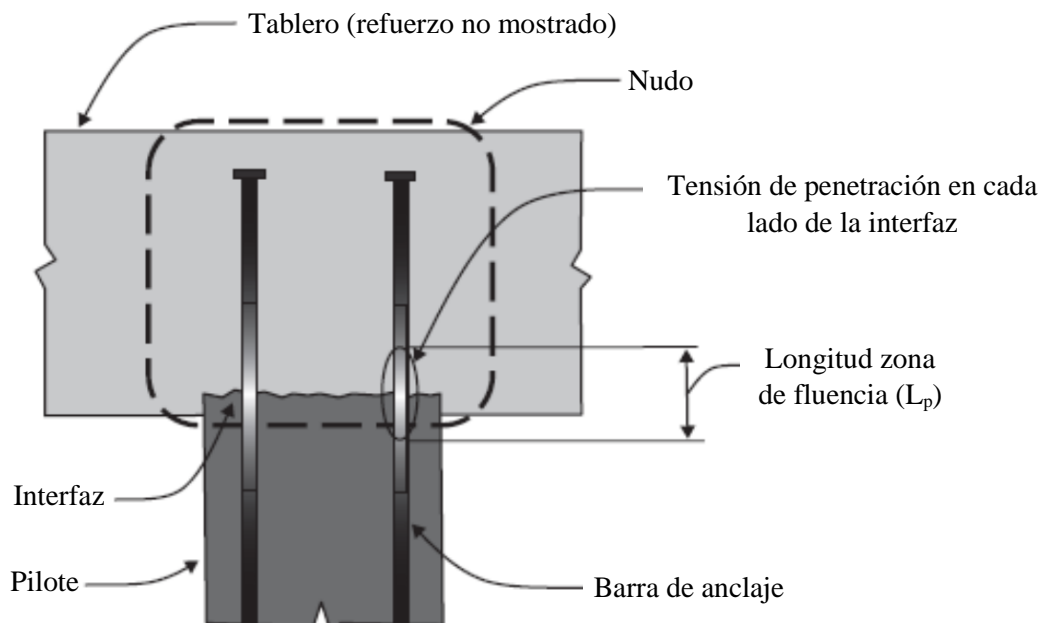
Elementos principales de conexión entre viga y pilote para muelles transparentes.
